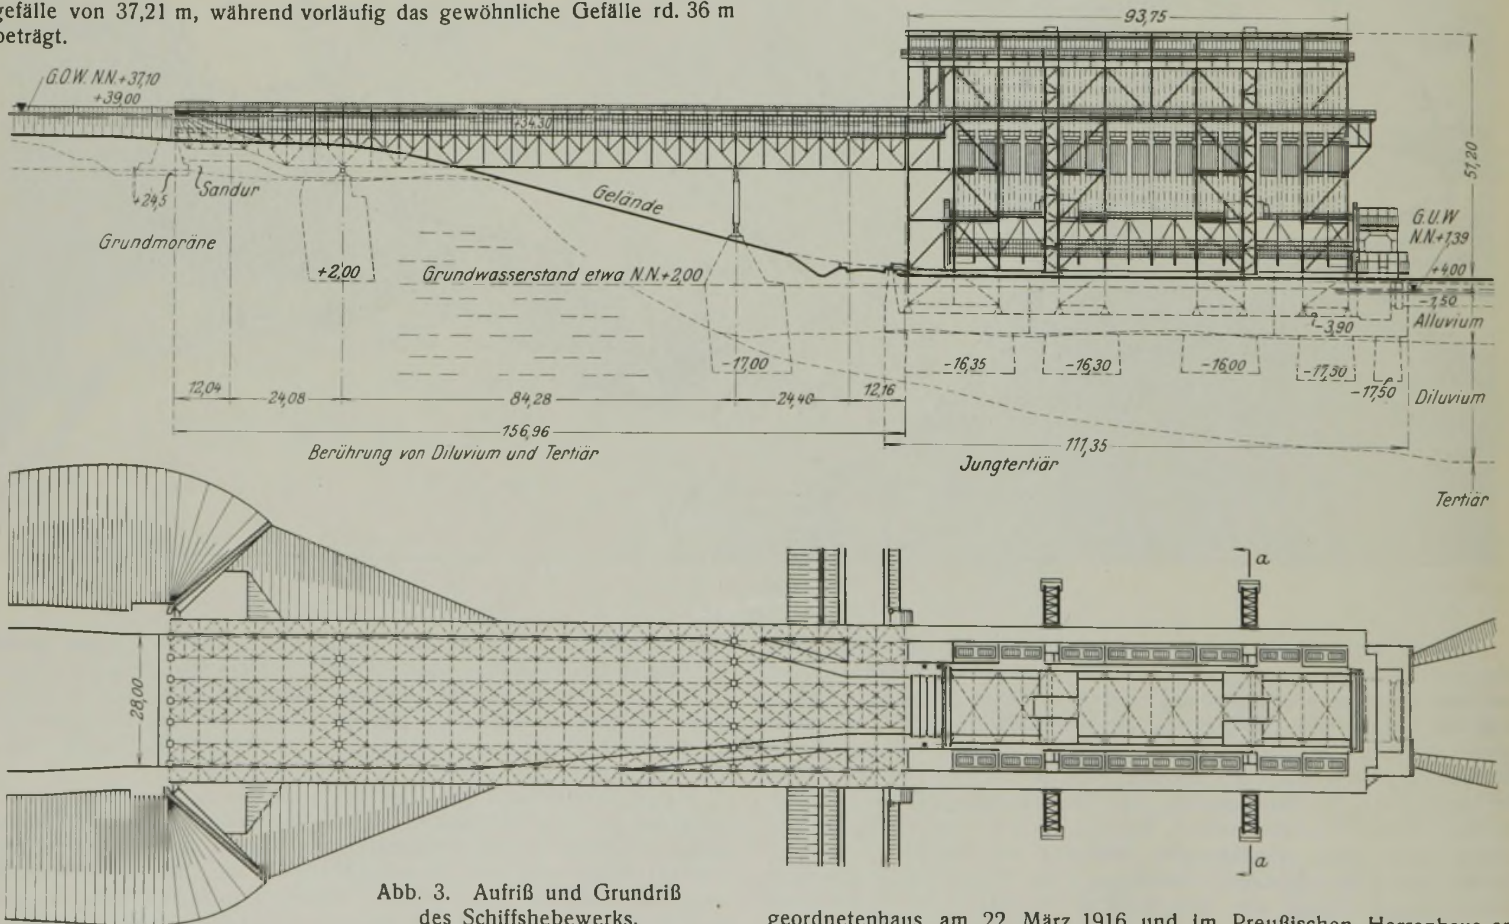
Aufriß und Grundriß des Schiffshebewerks.
